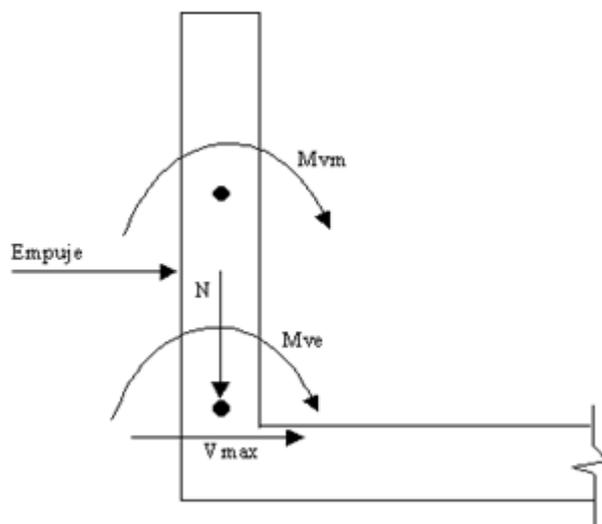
Sección en Planta de la Pared. Empuje del terreno sobre la CÁMARA
